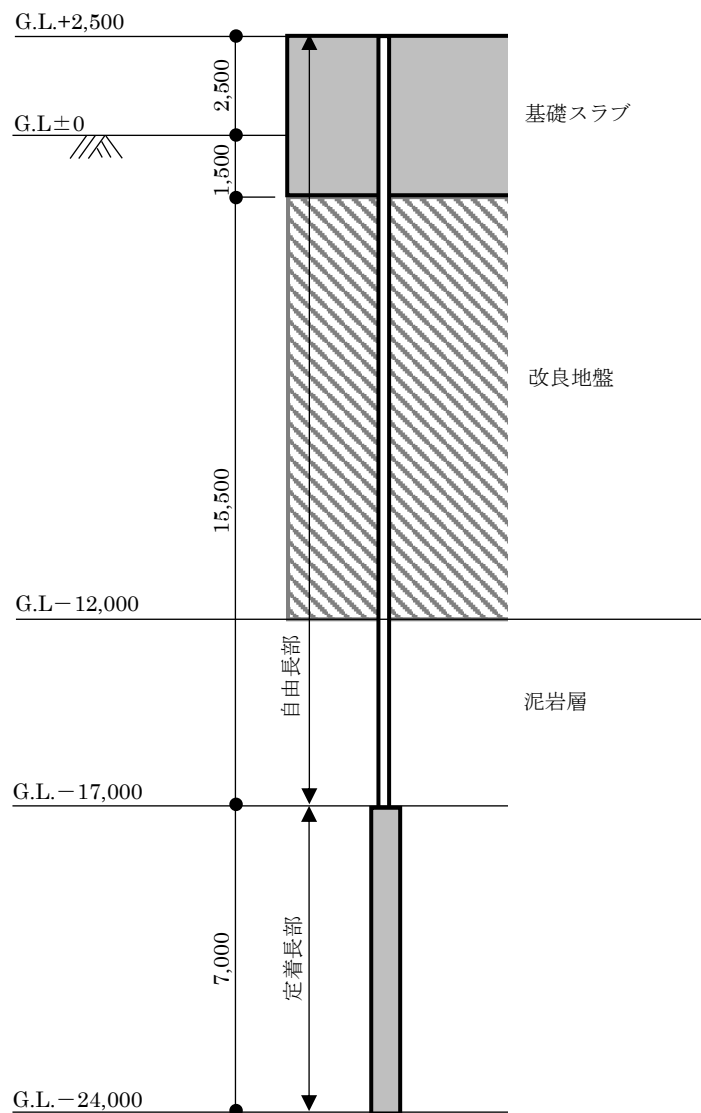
地盤アンカー設置計画 (単位：mm)
